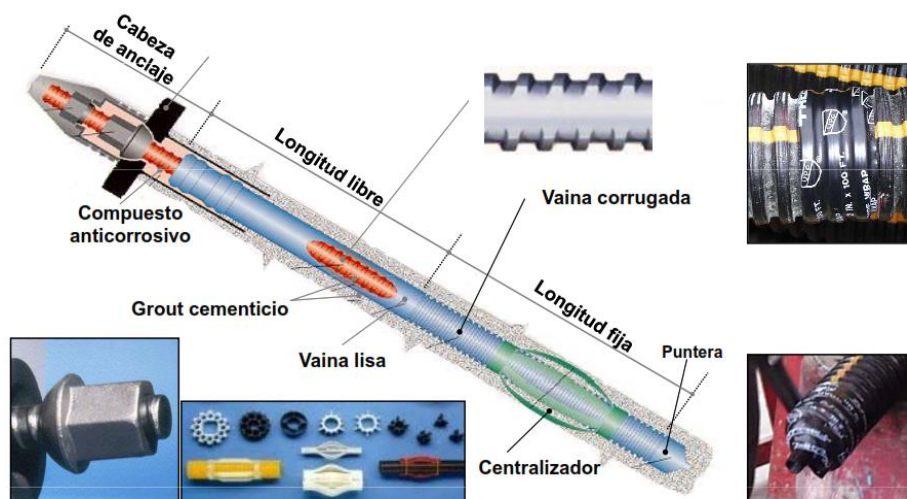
Elementos de anclaje colocados en etapa de montaje.
